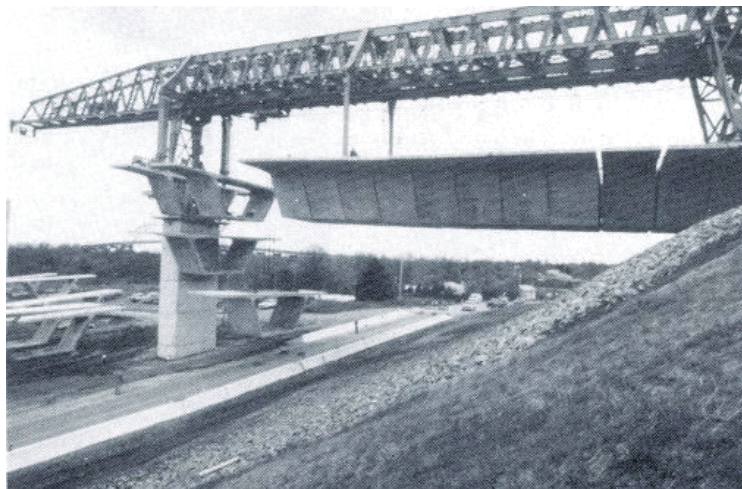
Construcción de un puente de dovelas con junta seca [CORVEN, 1993]
